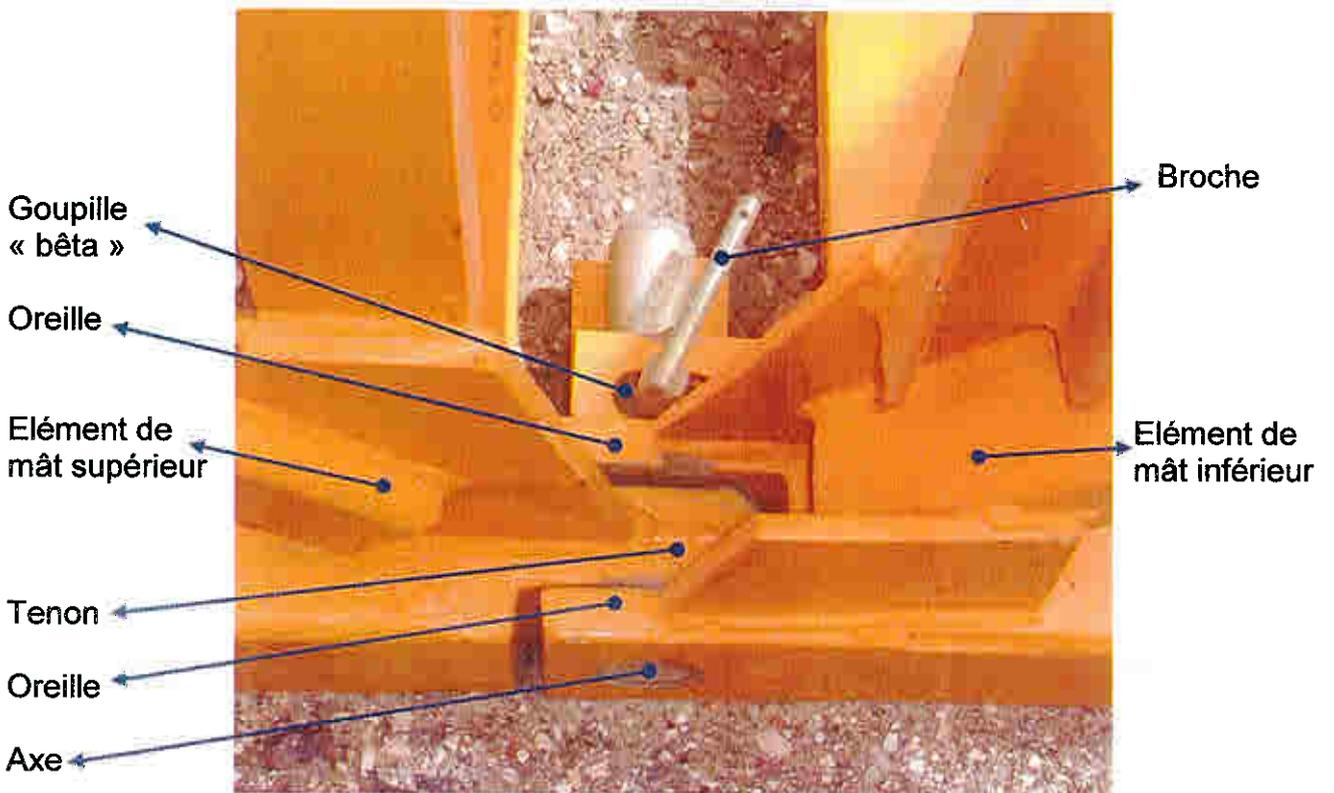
Exemple d'assemblage (le mât étant couché au sol)
